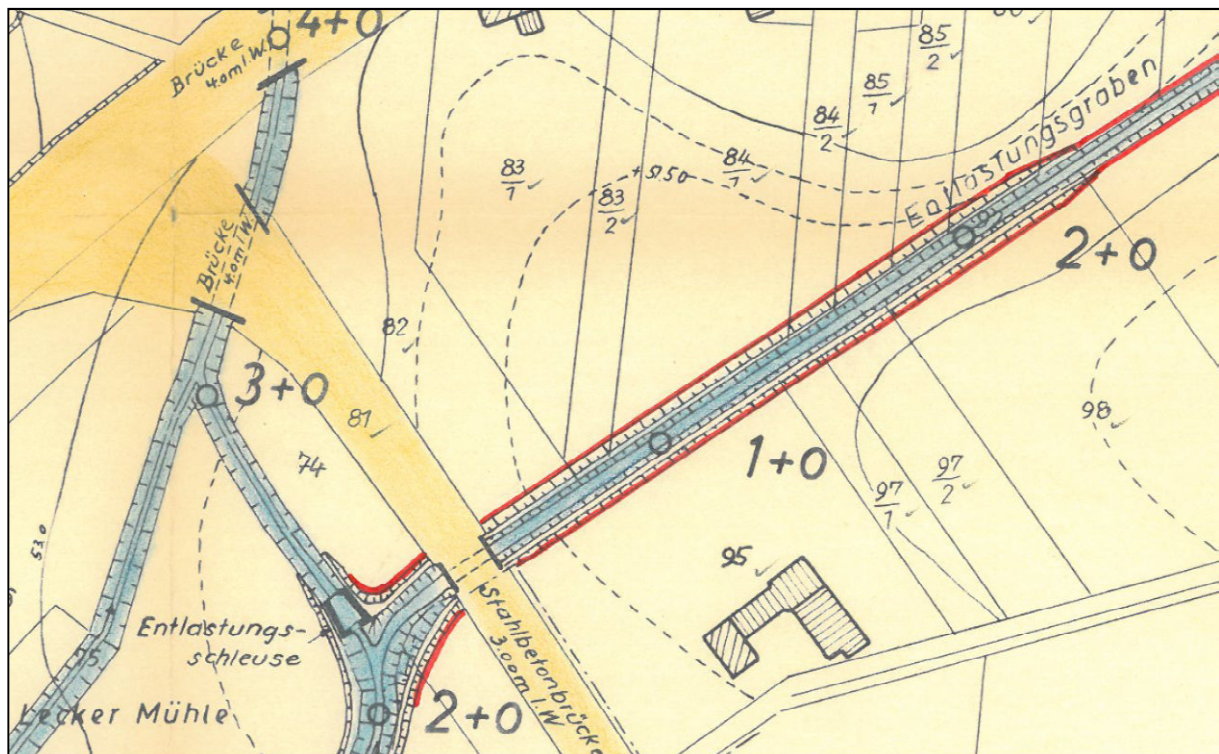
Auszug aus dem Lageplan zum Ausbau des Abschlages Leckermühlenbach (Anfang der 1970er Jahre)
